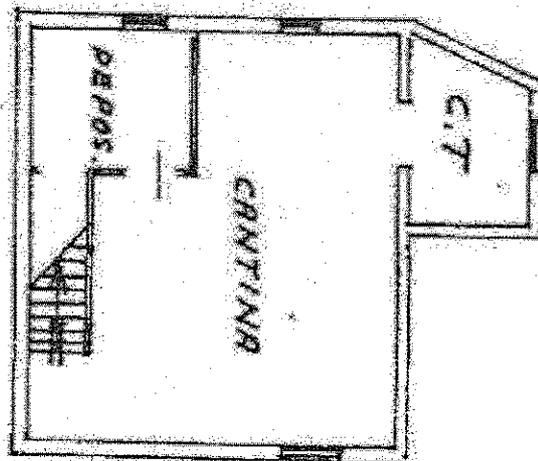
planimetria catastale ABITAZIONE PIANO TERRA-INTERRATO (fuori scala)
